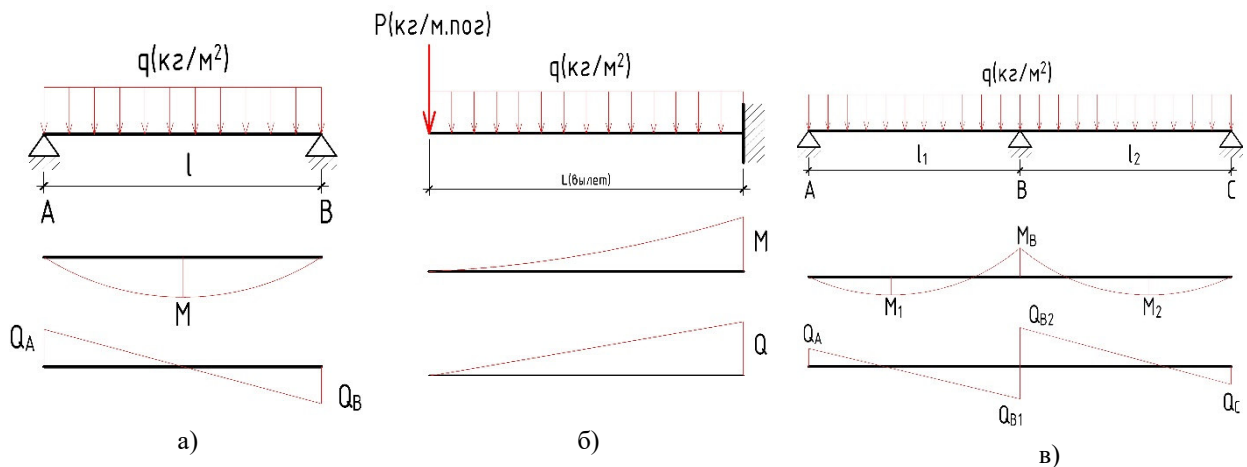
Расчетные схемы перекрытий. а) однопролетная балка; б) консоль; в) двухпролетная балка
